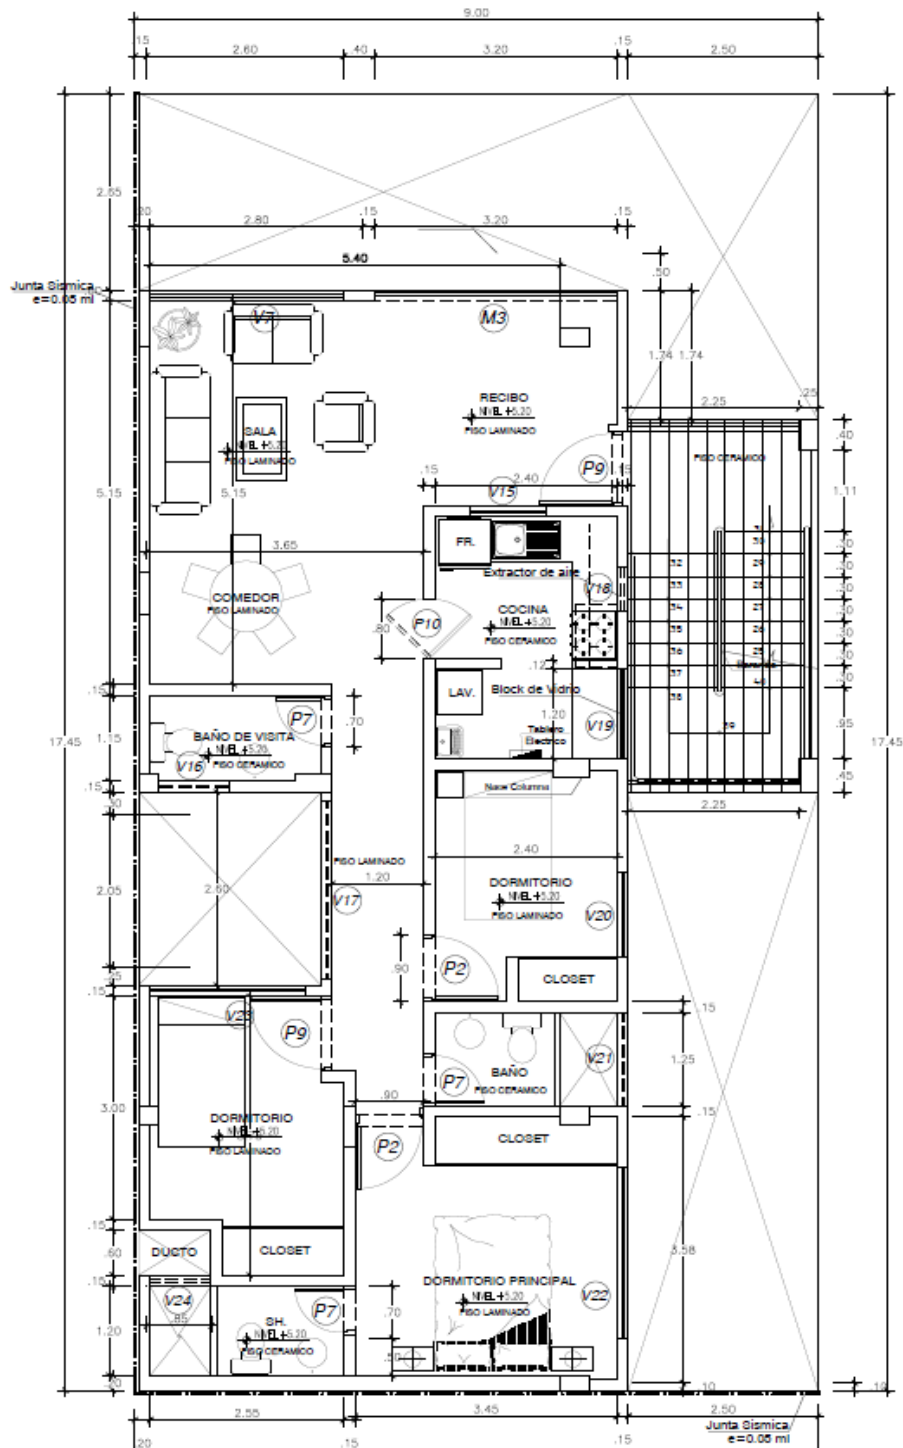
Planta 3°, 4° y 5° piso – Arquitectura
